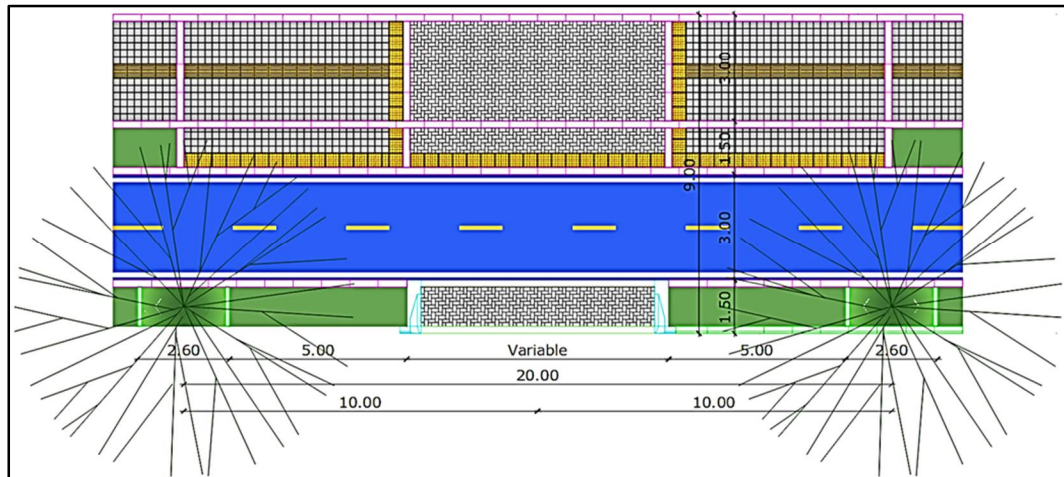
Propuesta Paisajismo y Rampas vehiculares de acceso a predios - Planta
